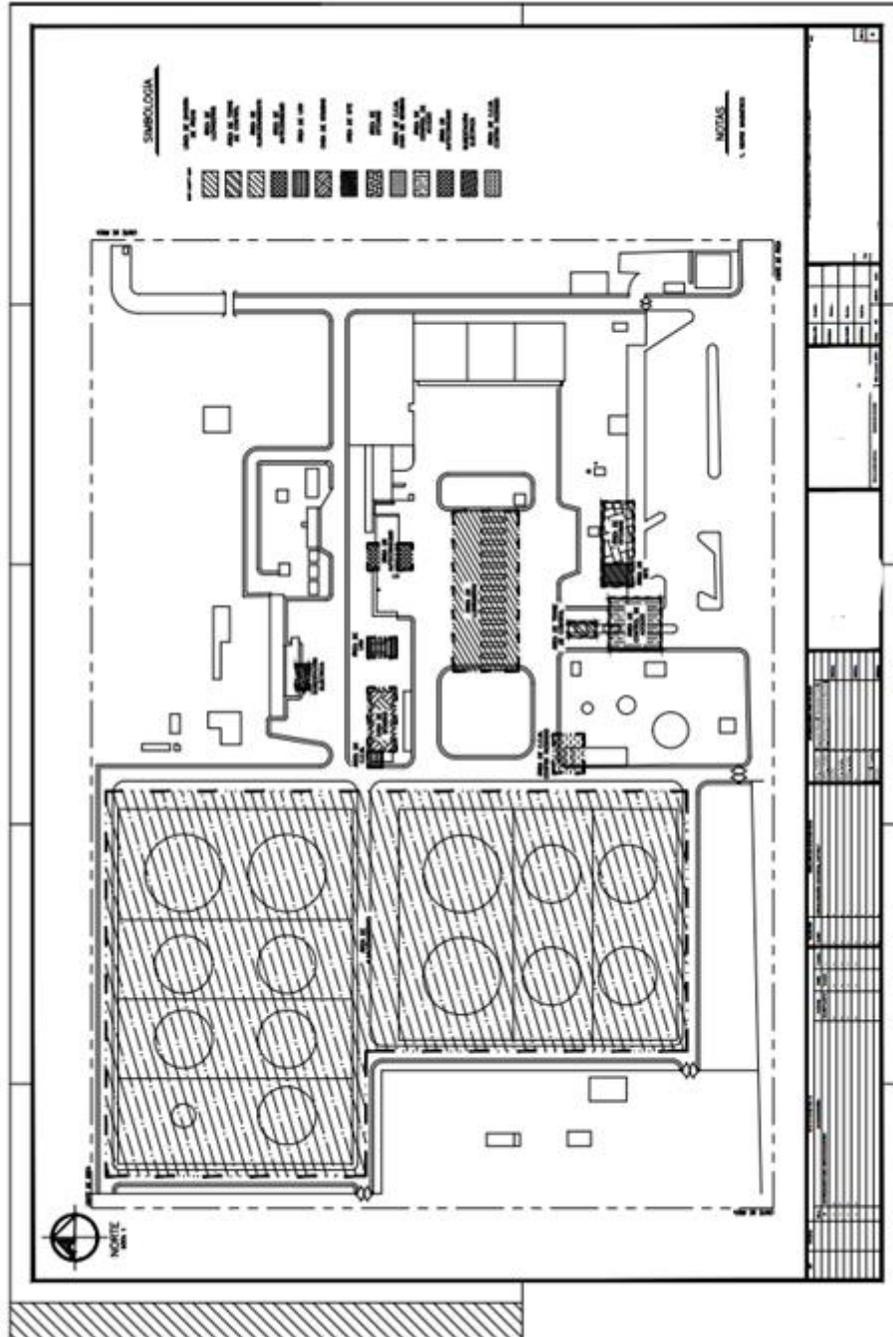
Plano De División De Áreas (fuente: IIESA plano B-002).
